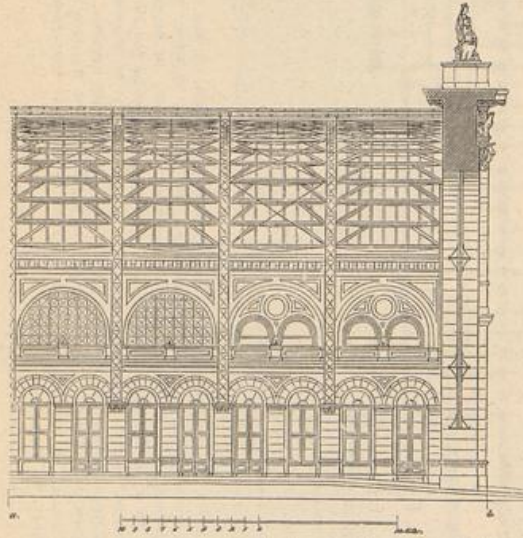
Empfangsgebäude der Berlin-Lehrter Bahn. Theil des Längenschnitts durch die Halle. (Maasstab 1:500.)
